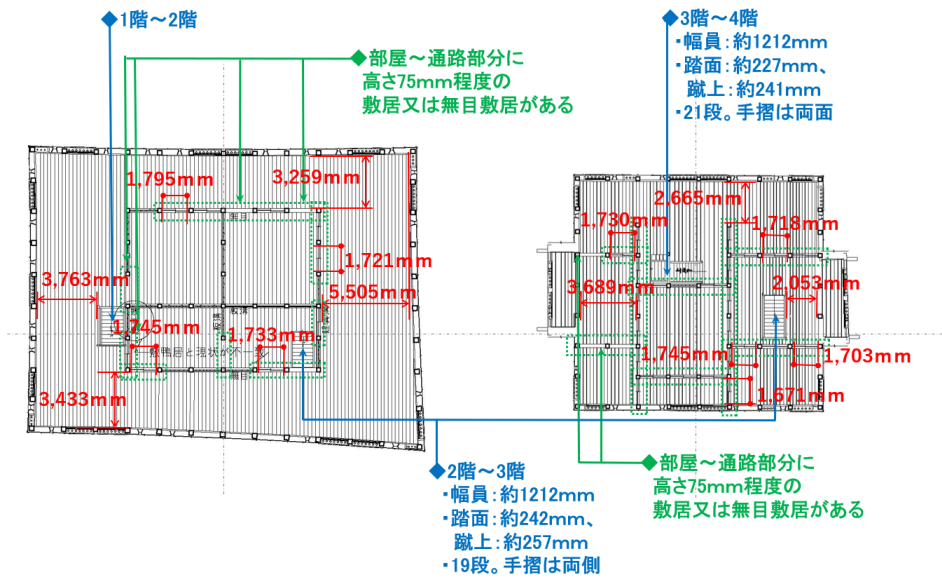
天守2階平面図及び天守3階平面図（復元原案）
